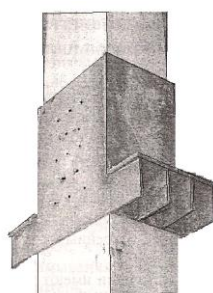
Опорный столик для ригелей, закрепленный к железобетонной колонне стальными анкерными болтами цангового типа
